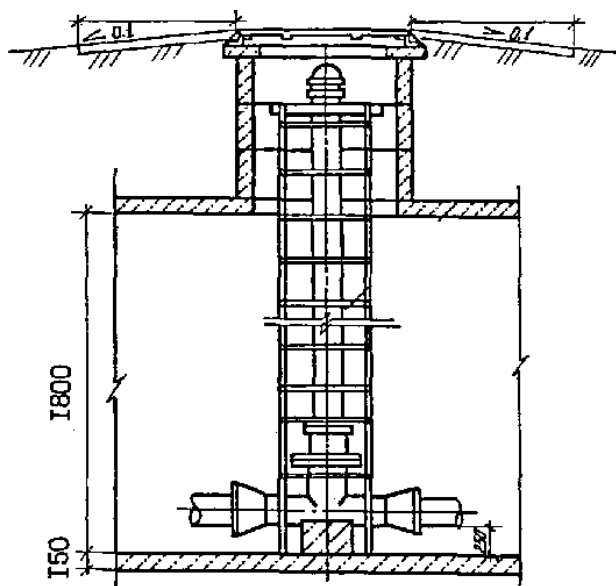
Схема установки пожарного гидранта на водопроводной сети
